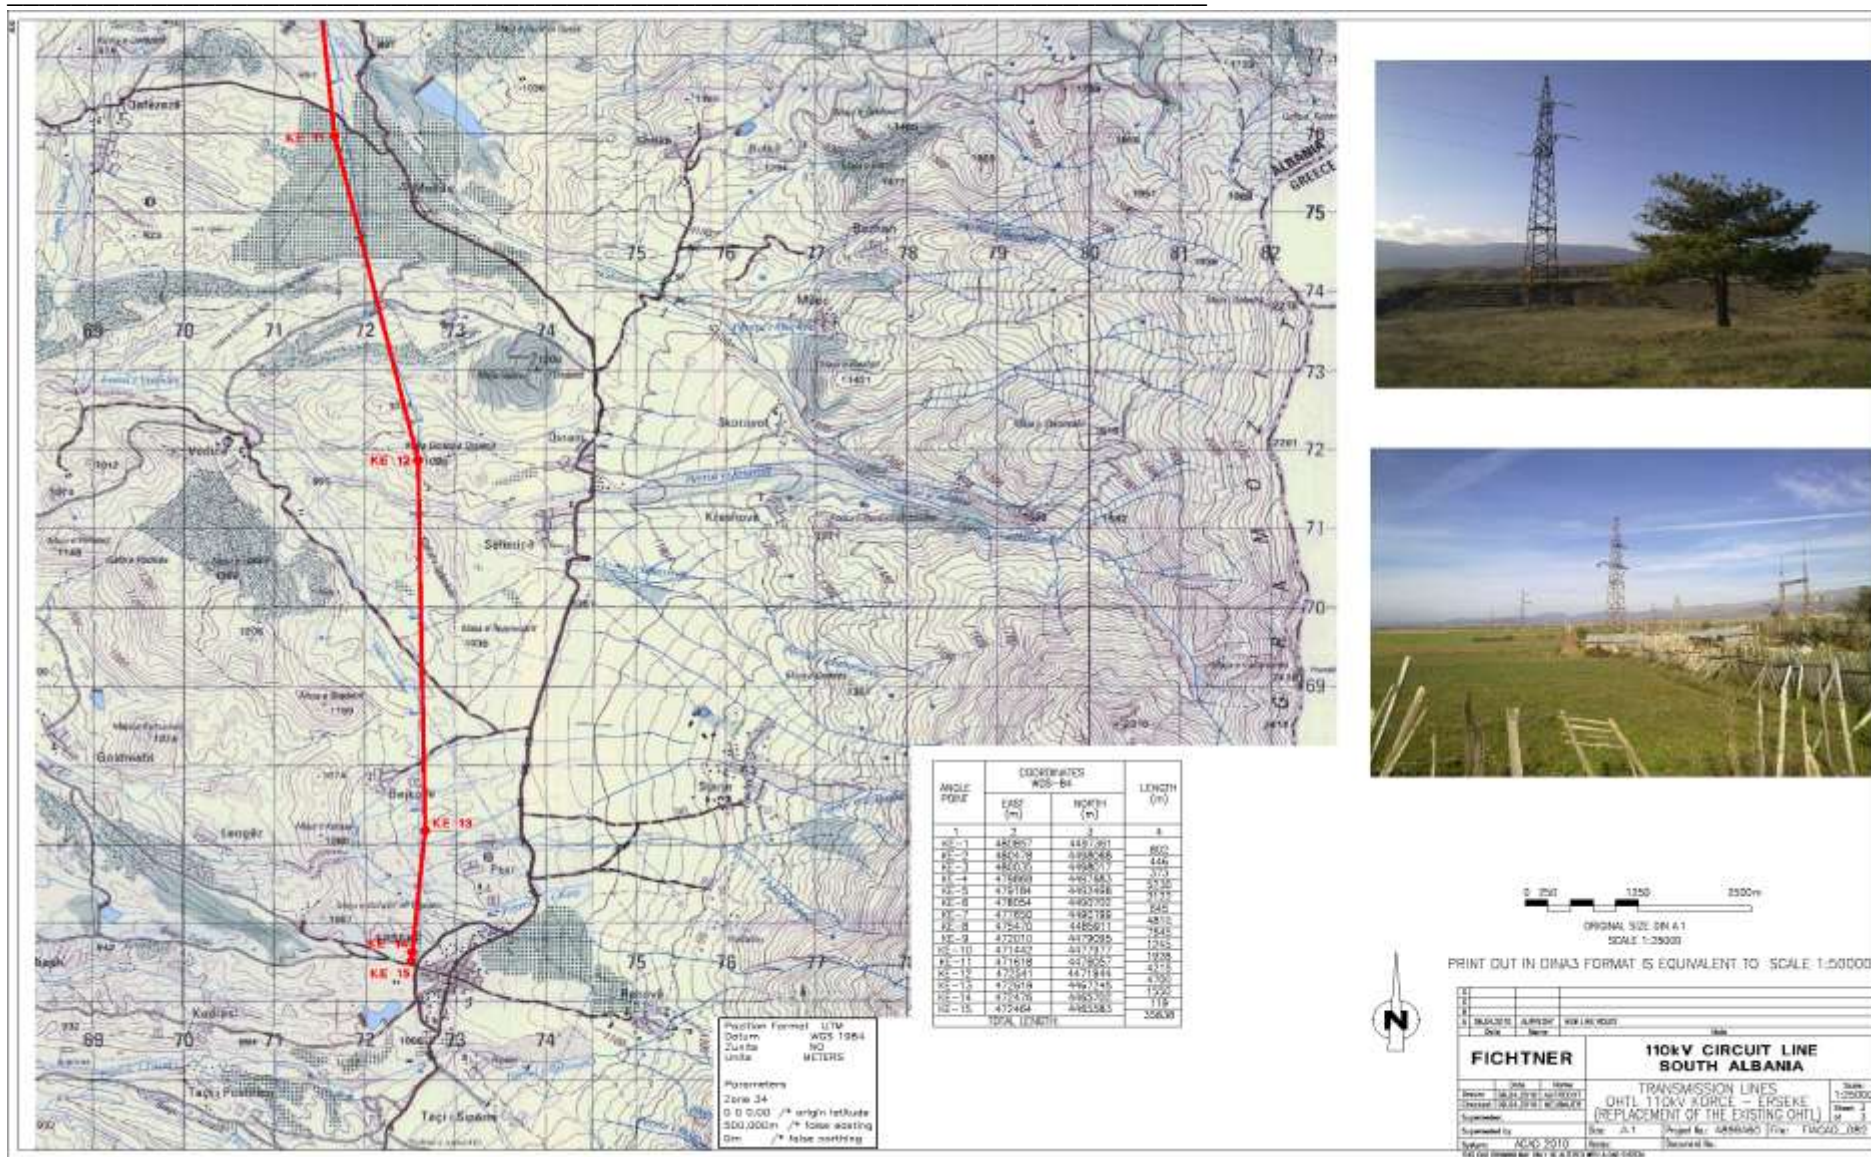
/6.: Planimetria e vendosjes se linjes 110 kV Erseke-Korce (harta pare)
